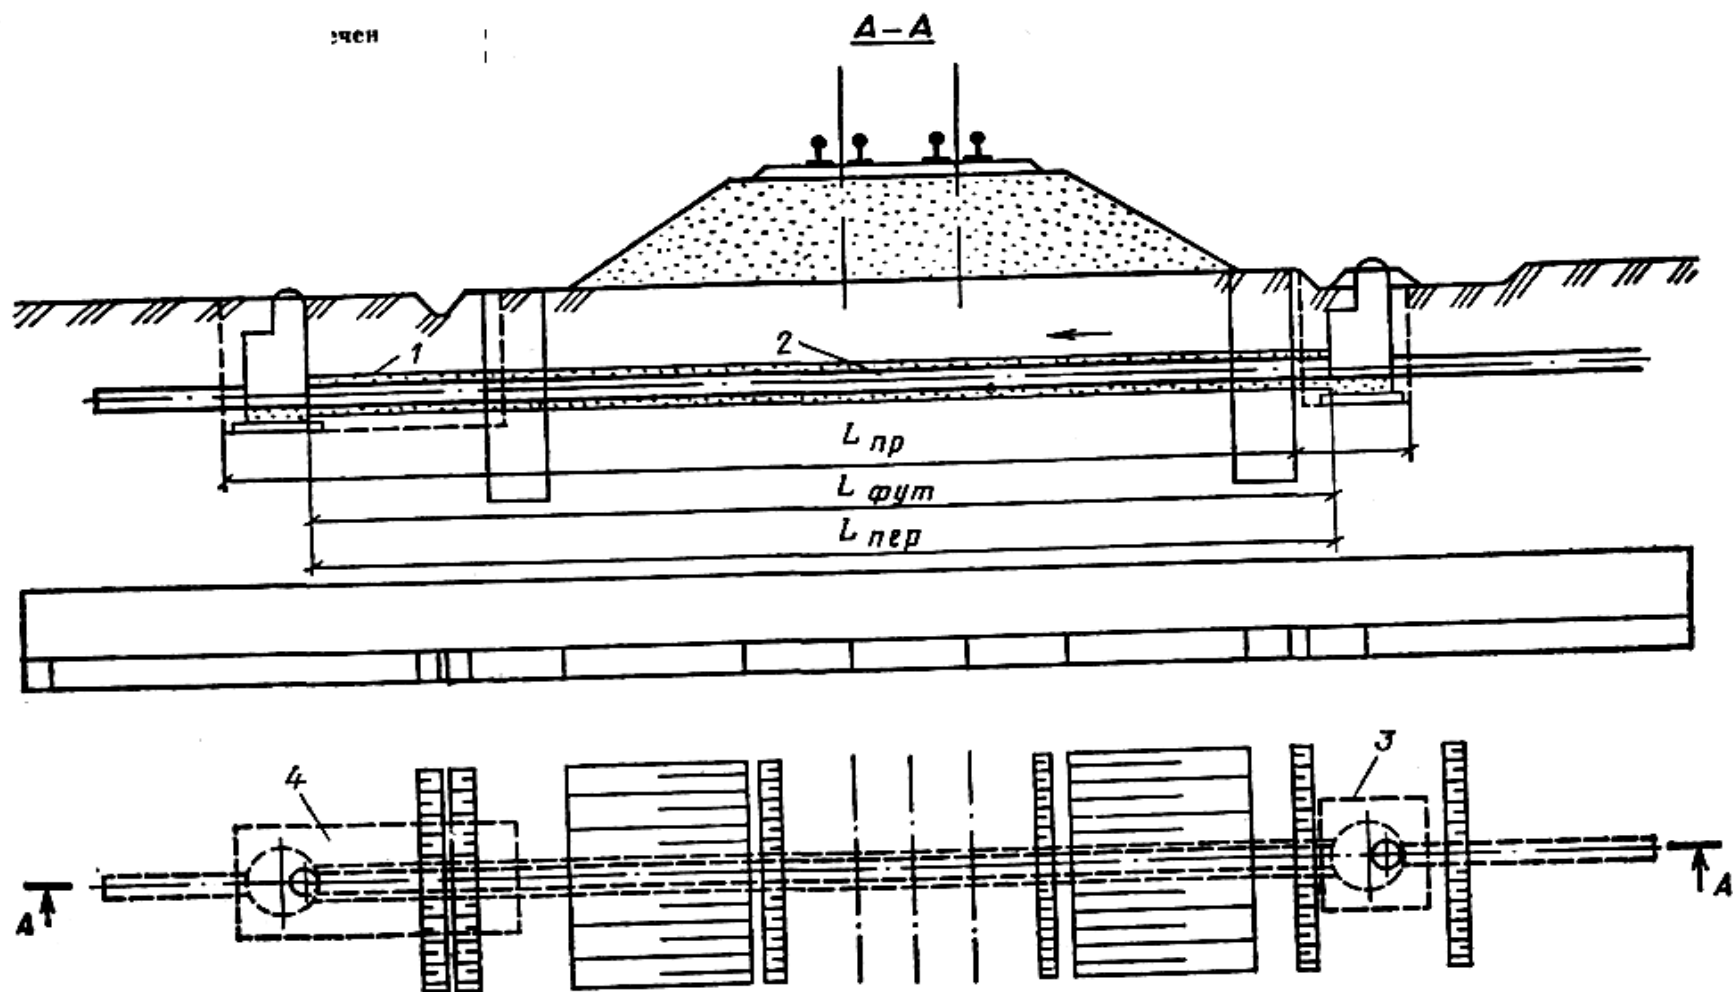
Схема пересечения самотечного трубопровода под железной дорогой на насыпи
